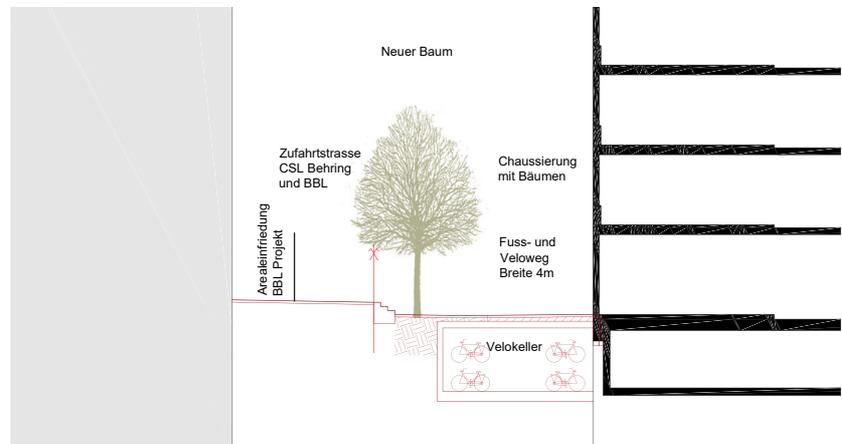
Ausschnitt BGK: Konzept für den Aussenraum südlich Solitär im östlichen Teil (Schemaschnitt Gebäude gemäss Machbarkeitsstudie),
